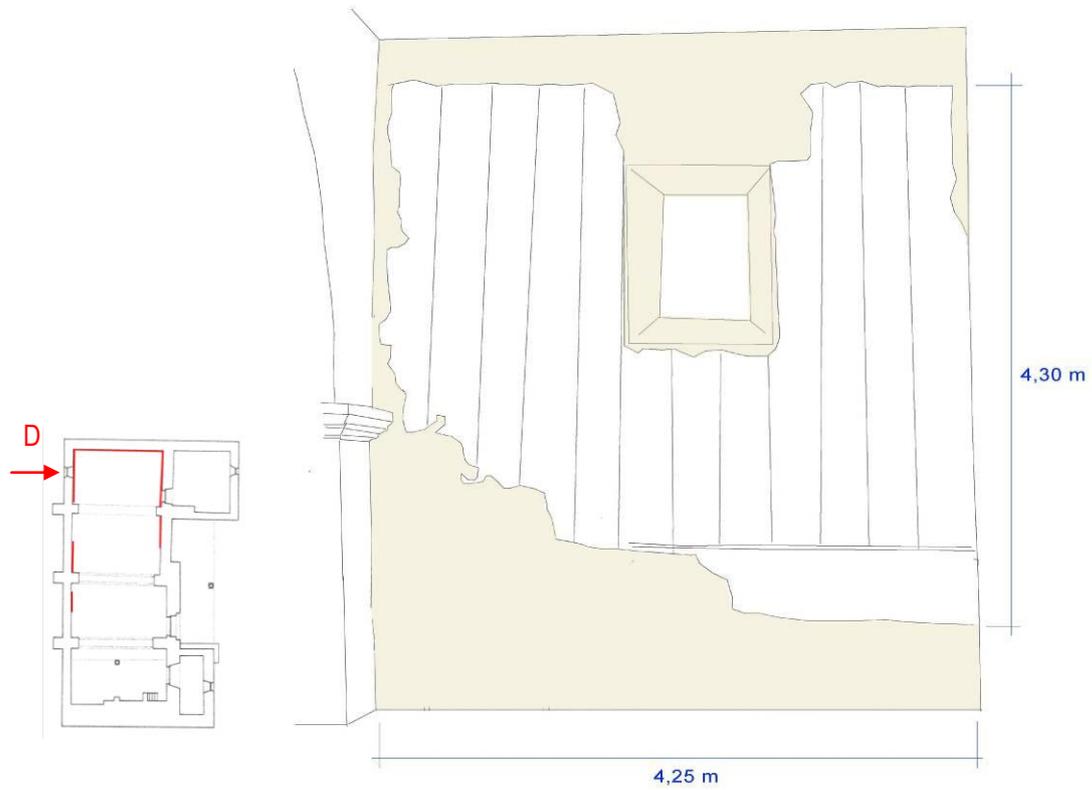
Muro D, cabecera, lado del evangelio. Esquema y dimensiones de las pinturas existentes.
